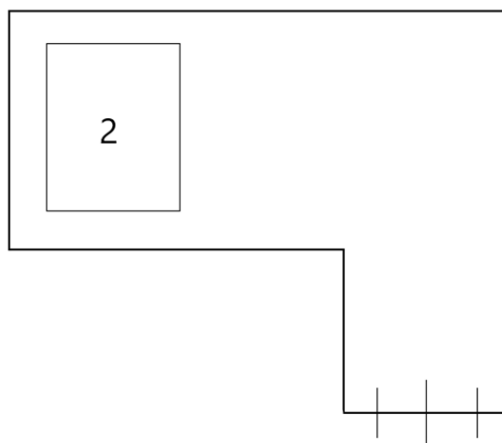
План размещения пожарной нагрузки в бойлерной
